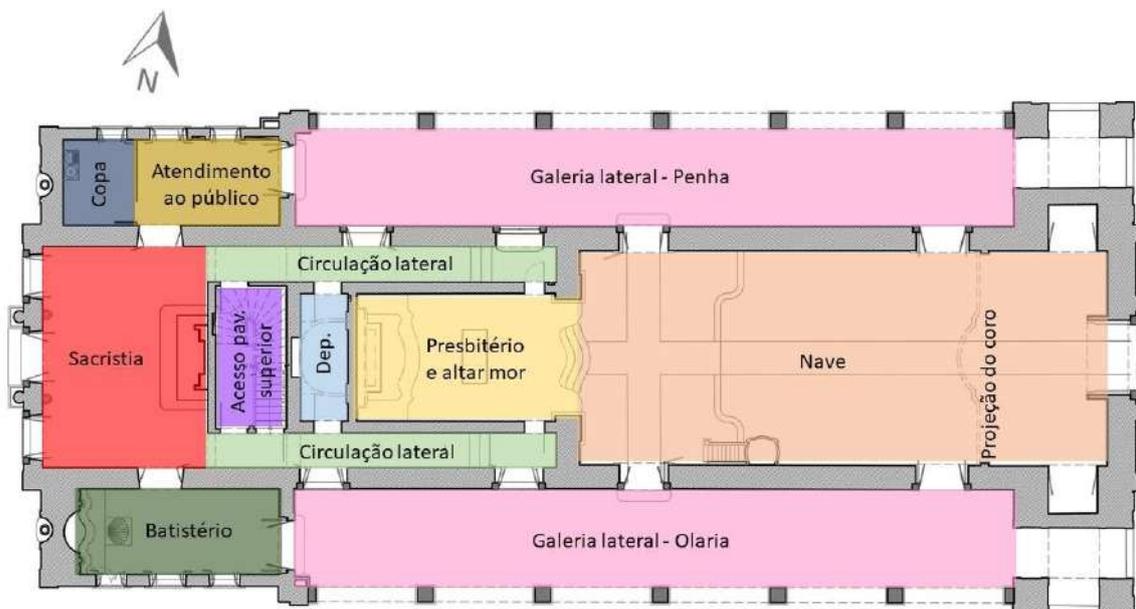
Planta do primeiro pavimento da Igreja da Penha (2019)
